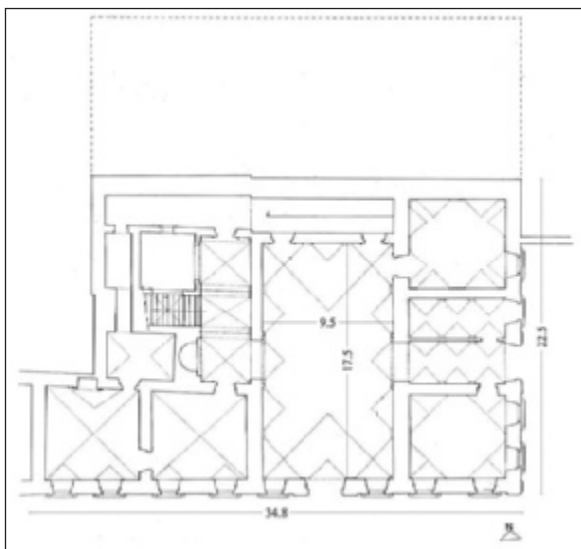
Pianta piano terra (ricostruzione dello stato originario).
